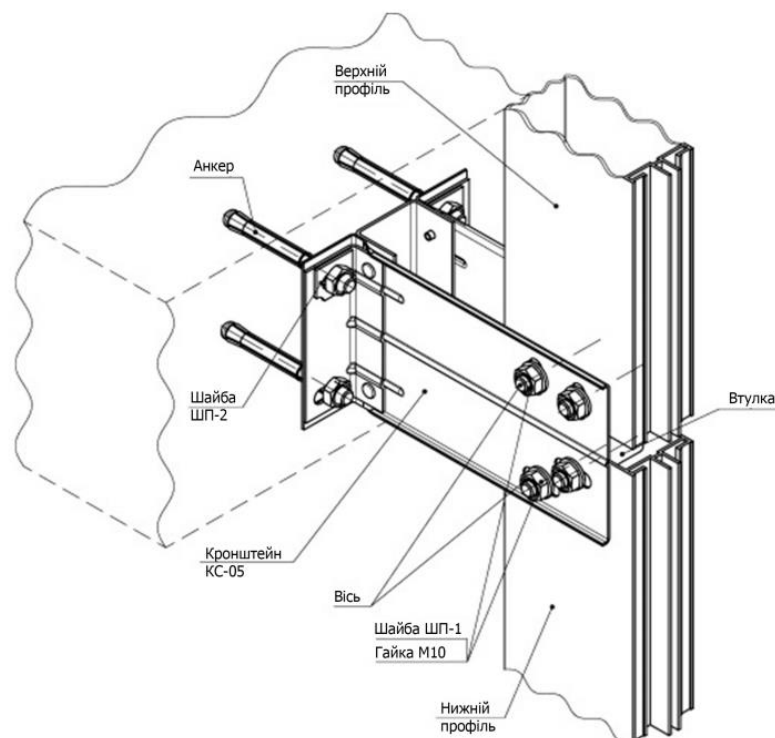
Вузол кріплення скляного фасаду на силовий кронштейн
